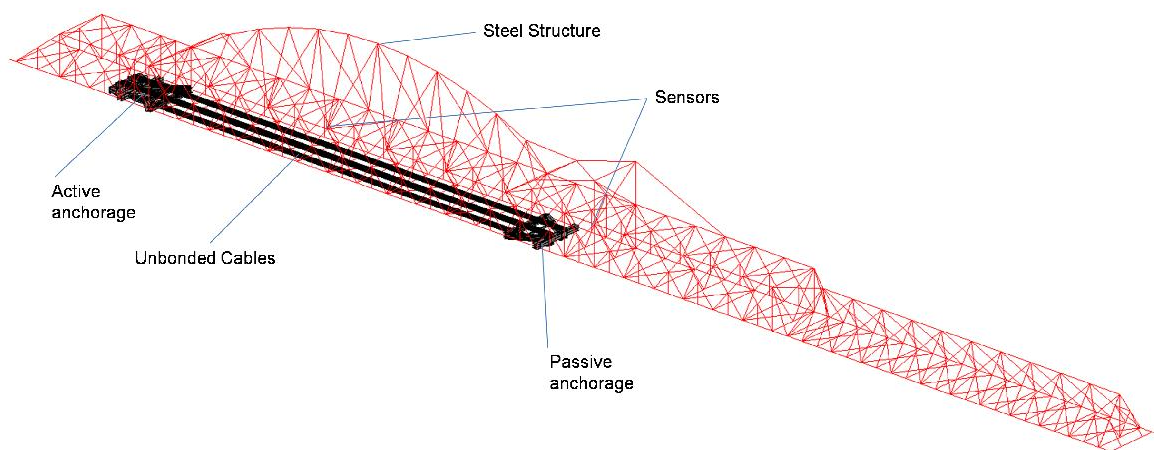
Sistema OPS em um cimbra autolanzável superior do tipo *Bowstring* [10].
